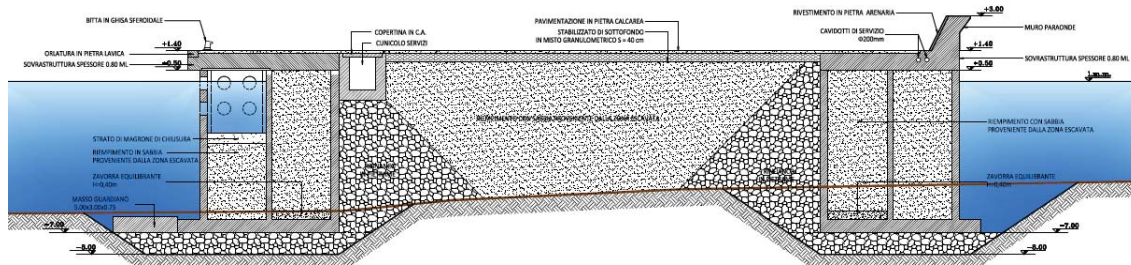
Sezione prolungamento molo di Levante – Tratto di radice
